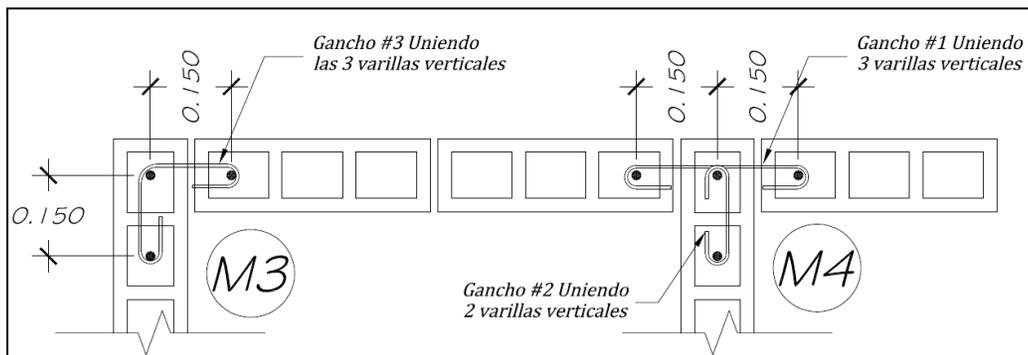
Traslape de Armaduras y Colocación de Acero Vertical
